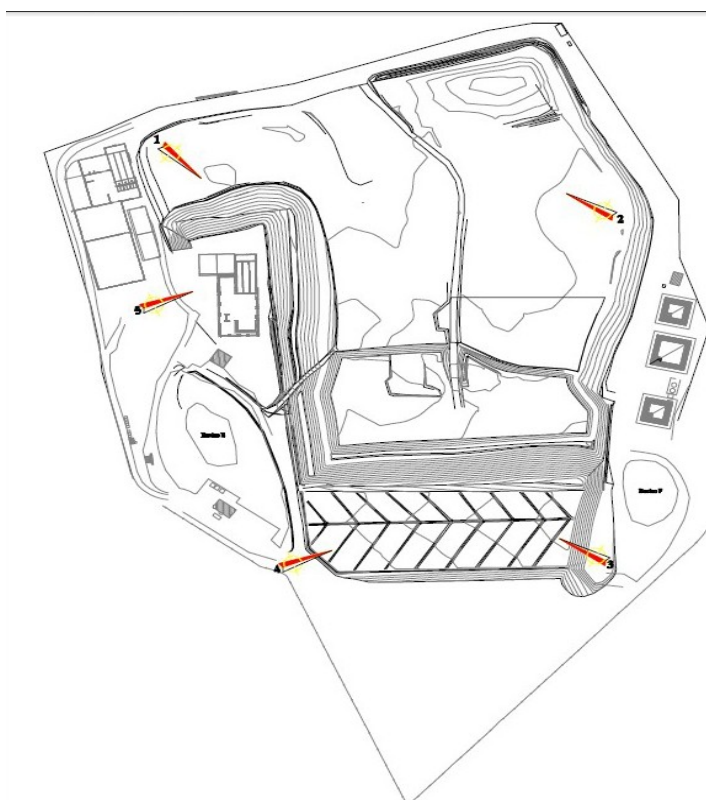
Sistemazione planimetrica con evidenziati i punti di presa delle foto
